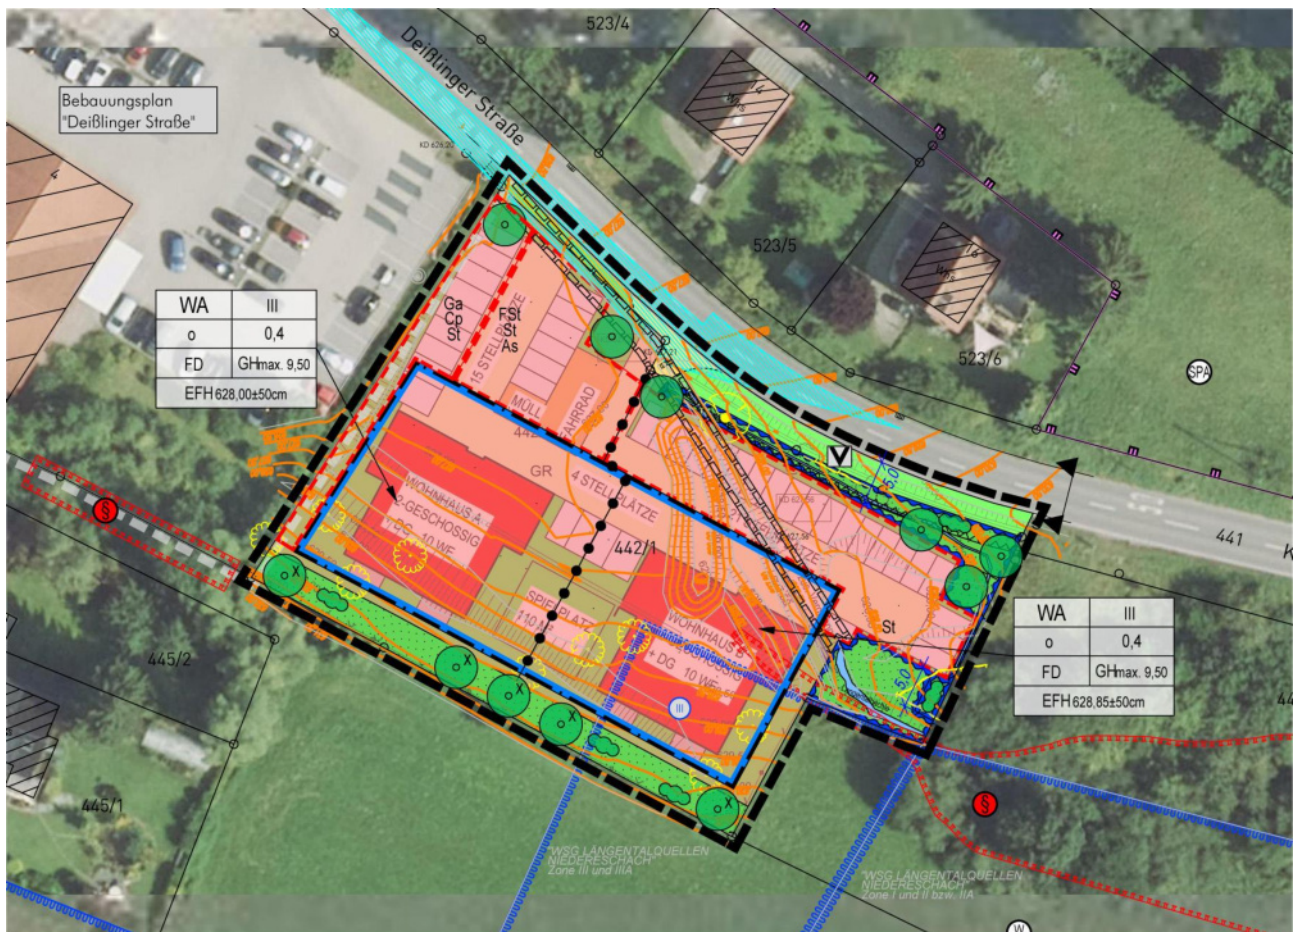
Bebauungskonzept (2022) mit Überlagerung der Festsetzungen des BPlanes und digitalem Orthophoto
